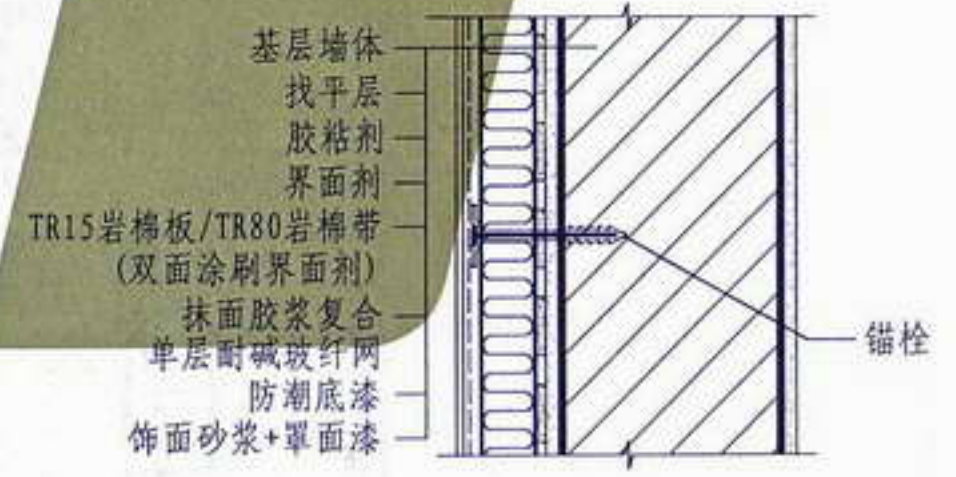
B系统 (单层耐碱玻纤网) 墙体构造示意
